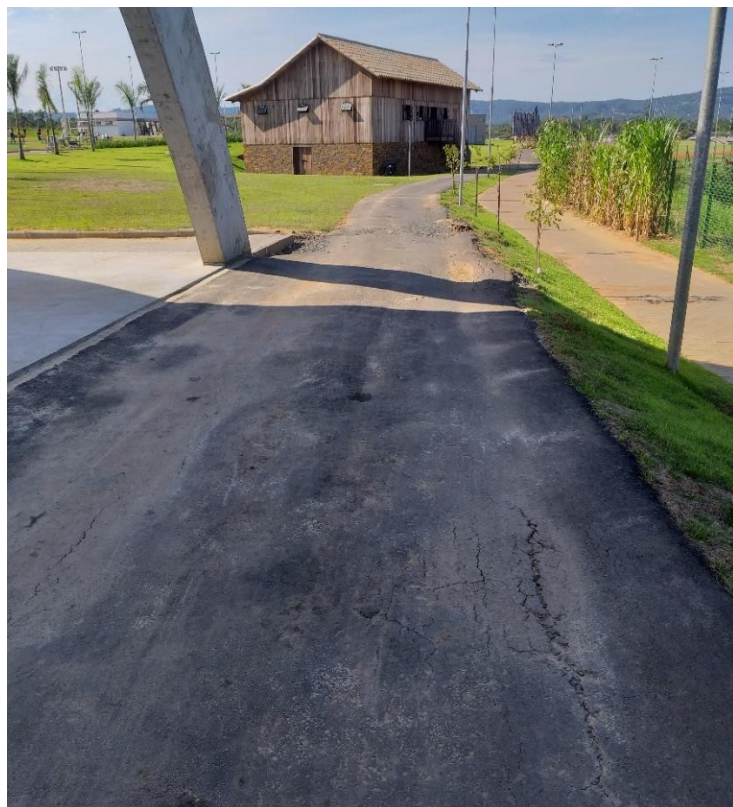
Pavimentação danificada. (Fonte: Dos Autores 2019)
